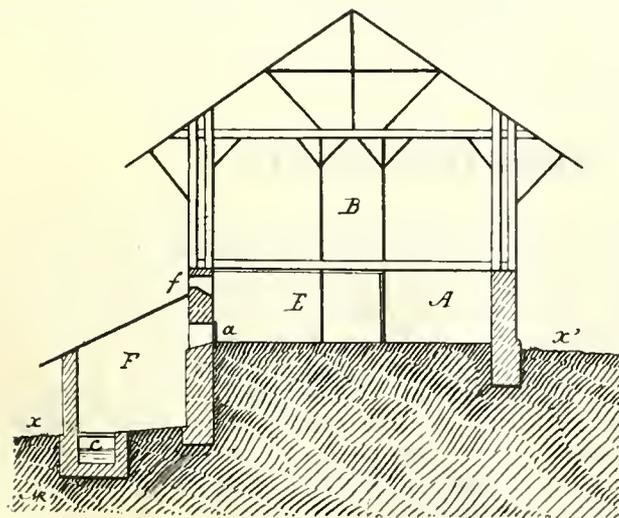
Coupe transversale d'une fumière couverte. Disposition suisse.
